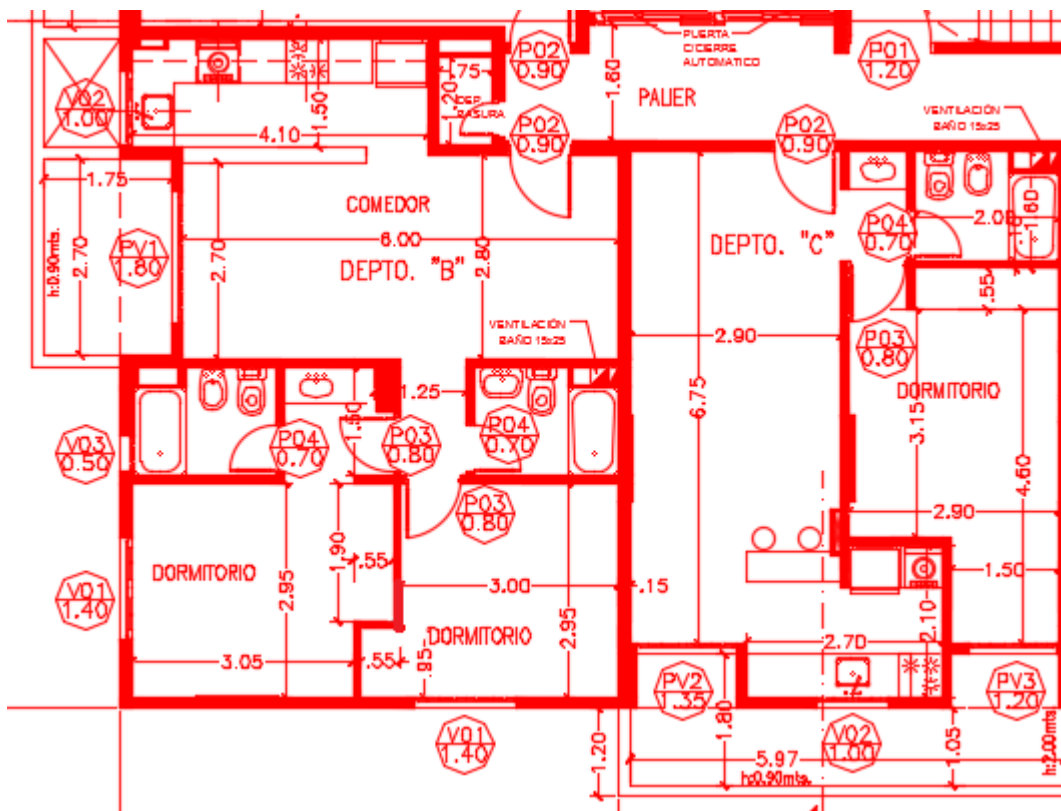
Detalle de los departamentos de las plantas tipo.
